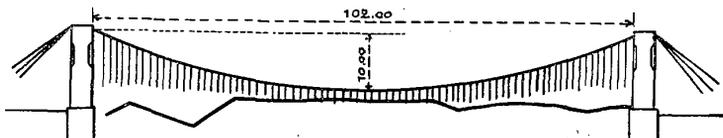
Elévation schématique de l'ouvrage après l'ouragan.
